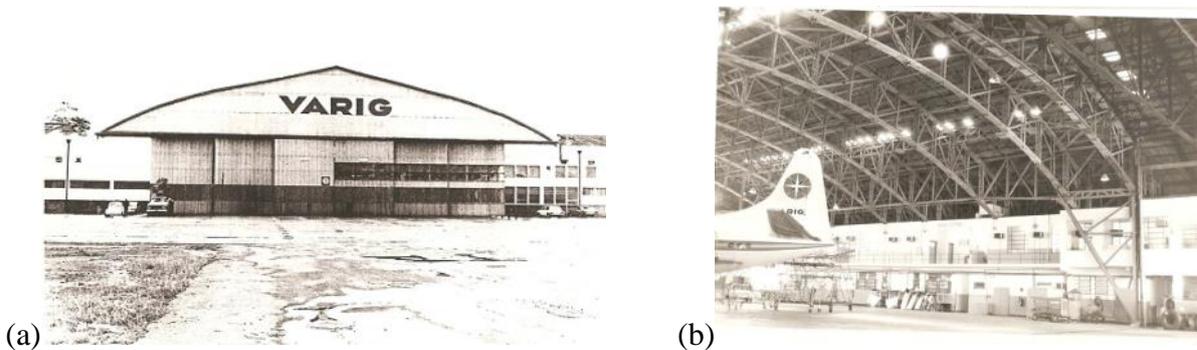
Sistema Estrutural de coberturas com arcos treliçados de madeira: Hangar construído em 1949, no Aeroporto de Congonhas em São Paulo, com aproximadamente 70 metros de vão.
